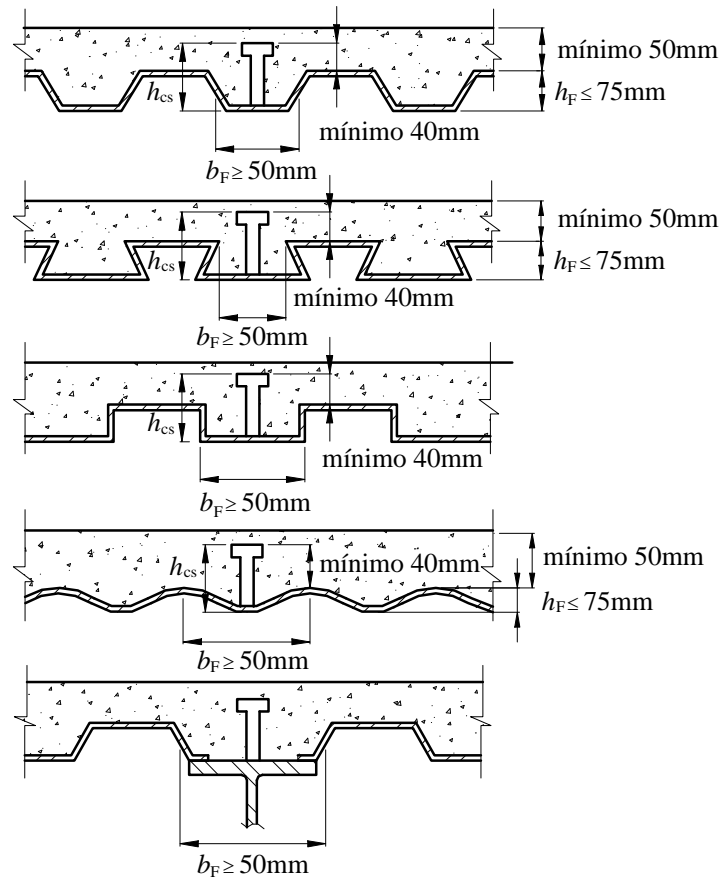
Lajes de concreto com fôrma de aço incorporada
